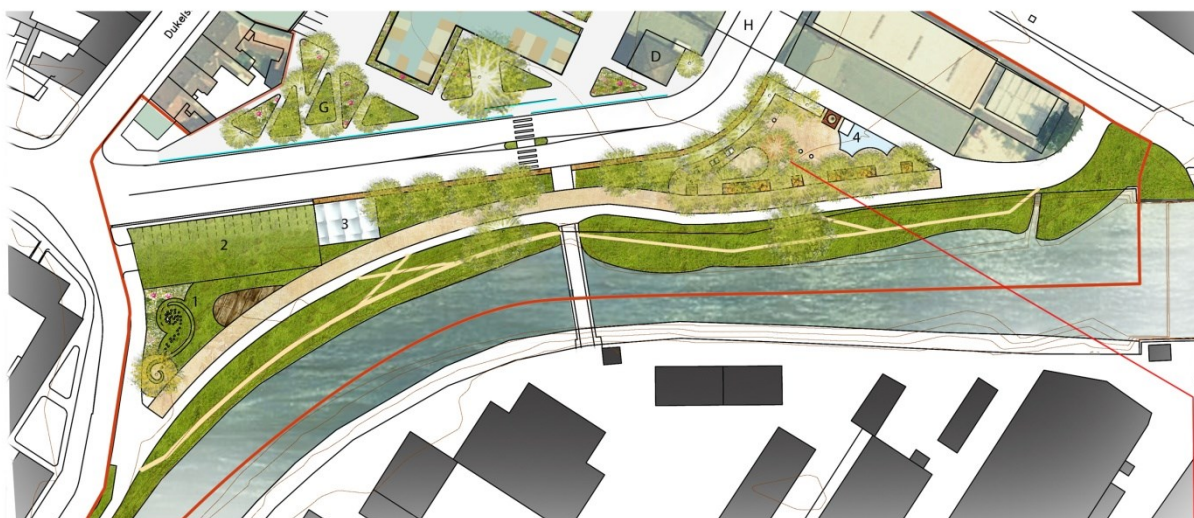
Detail úpravy volného prostoru kolem polyfunkční budovy
